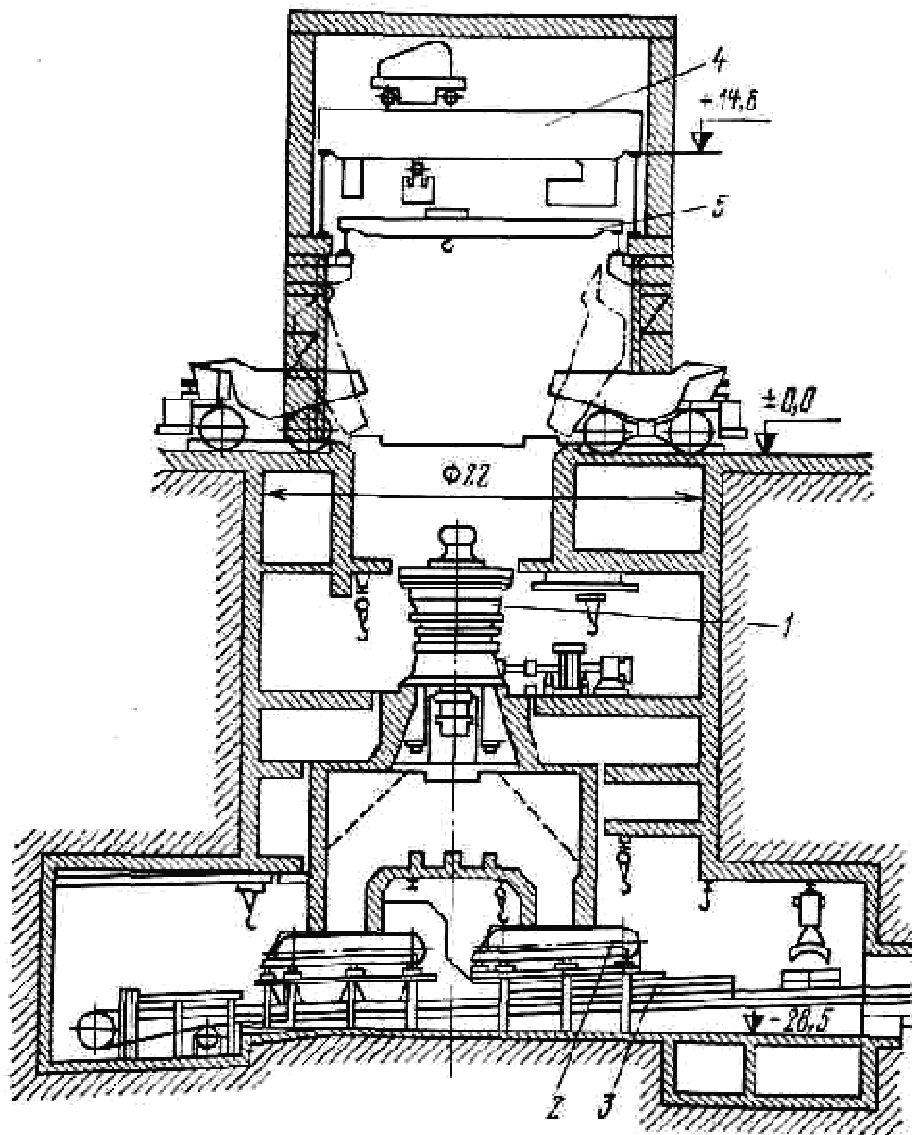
Дробильный перегрузочный пункт (Ингулецкий ГОК) с конусной дробилкой (линейные размеры — в метрах): 1 — дробилка конусная; 2 — питатель пластинчатый; 3 — конвейер ленточный; 4, 5 — краны мостовые
